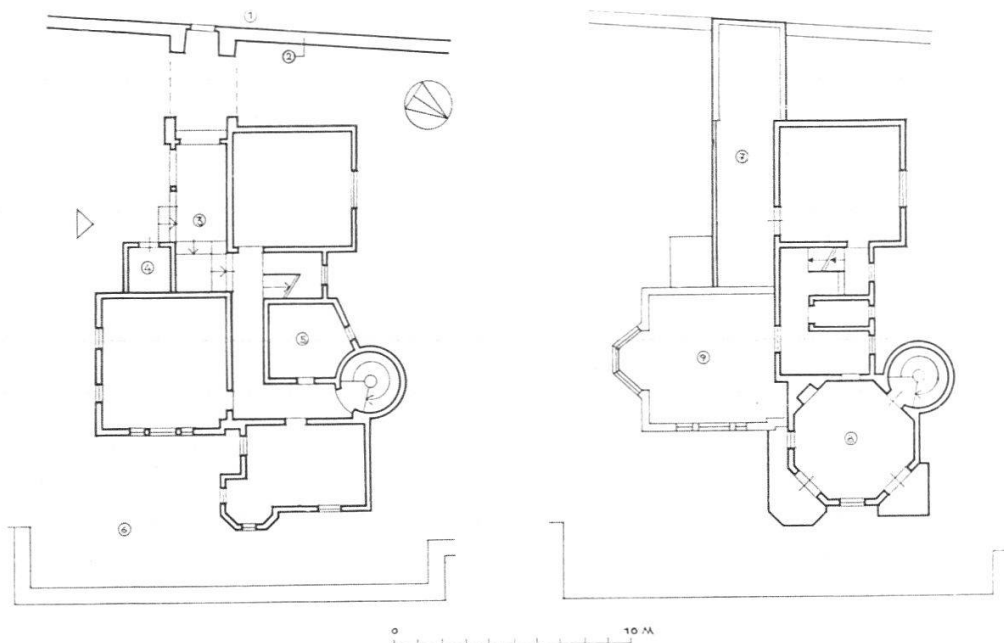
Grundrißrekonstruktionen. *Im Erdgeschoß*: 1 Bürglistraße, 2 Umfassungsmauer, 3 gedeckte Eingangshalle, 4 Abgang zur Küche, 5 Nebenräume, 6 Terrasse. *Im Obergeschoß*: 7 Veranda, 8 Rittersaal, 9 Erkerzimmer, 1888 entstanden (Zeichnung des Verfassers)
